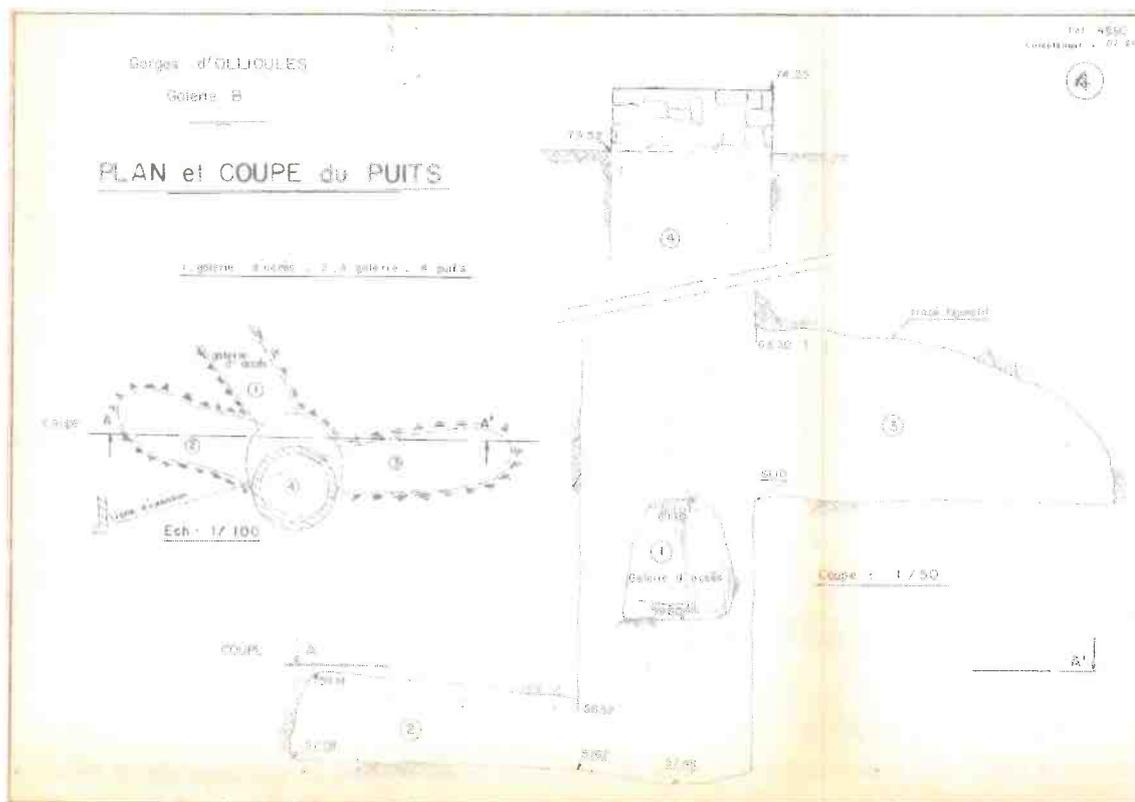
plan et coupe du puits (source : Cabinet BUET)
